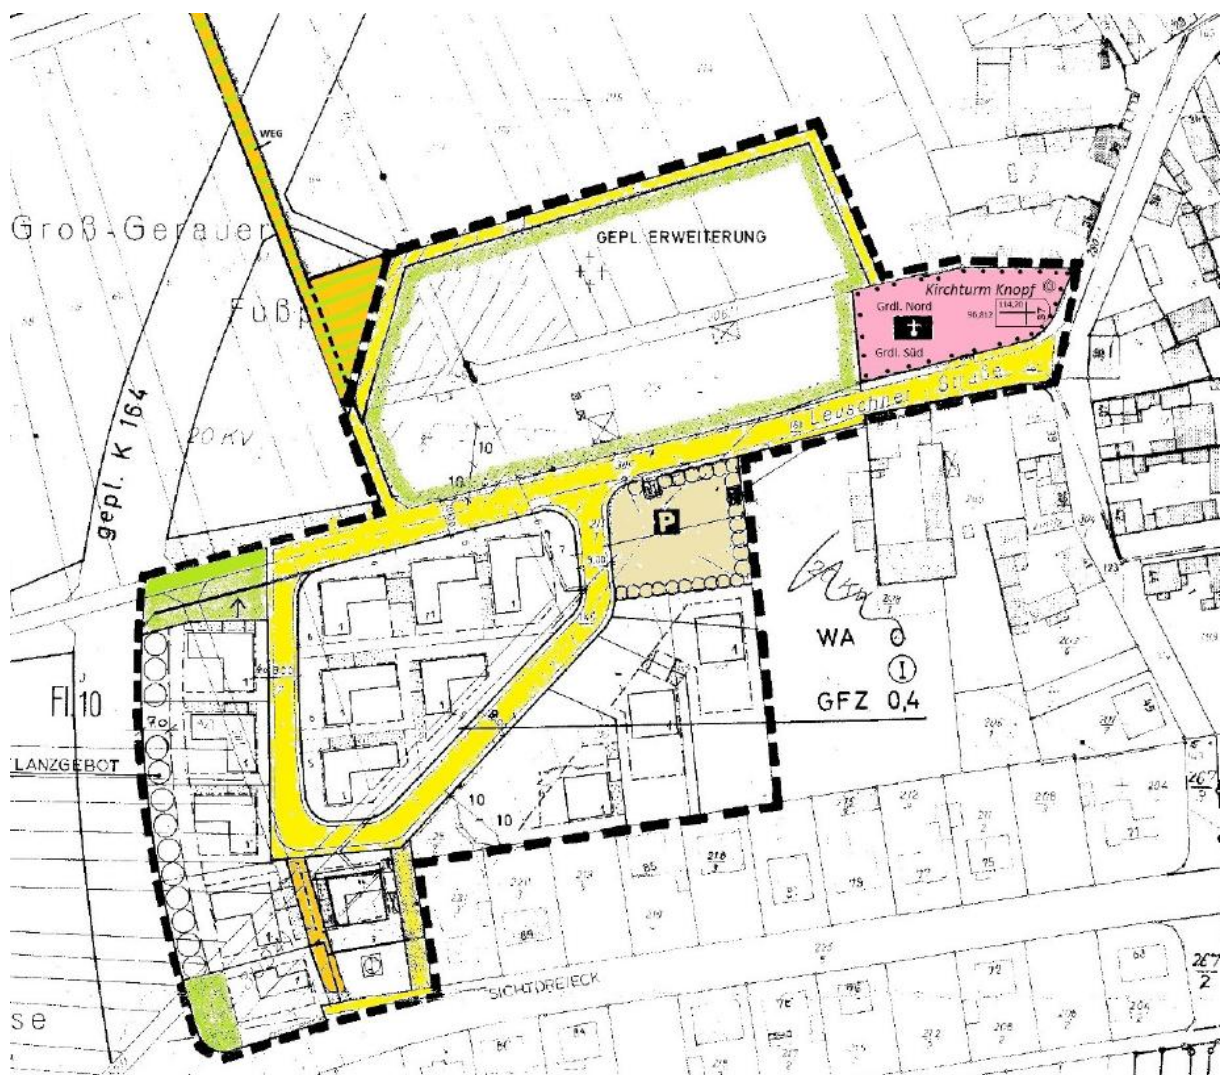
Bebauungsplan "Am Heißgraben" Südwestlich des Plangebietes
